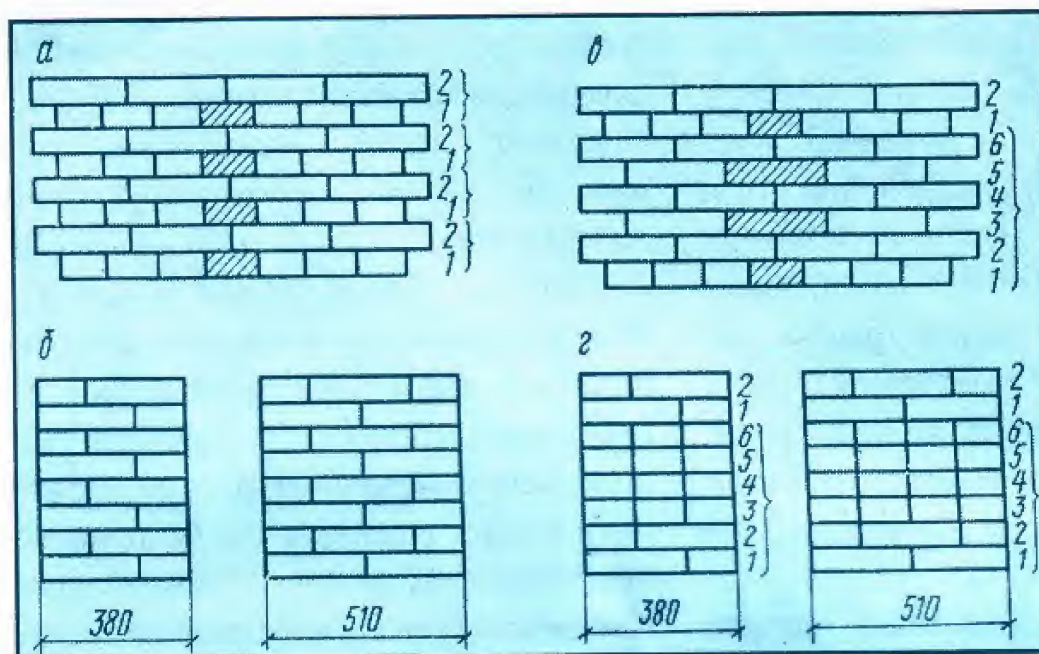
Системи кладки: а - фасад дворядної системи кладки; б - перерізи; в - фасад шестирядної системи кладки; г - перерізи.
